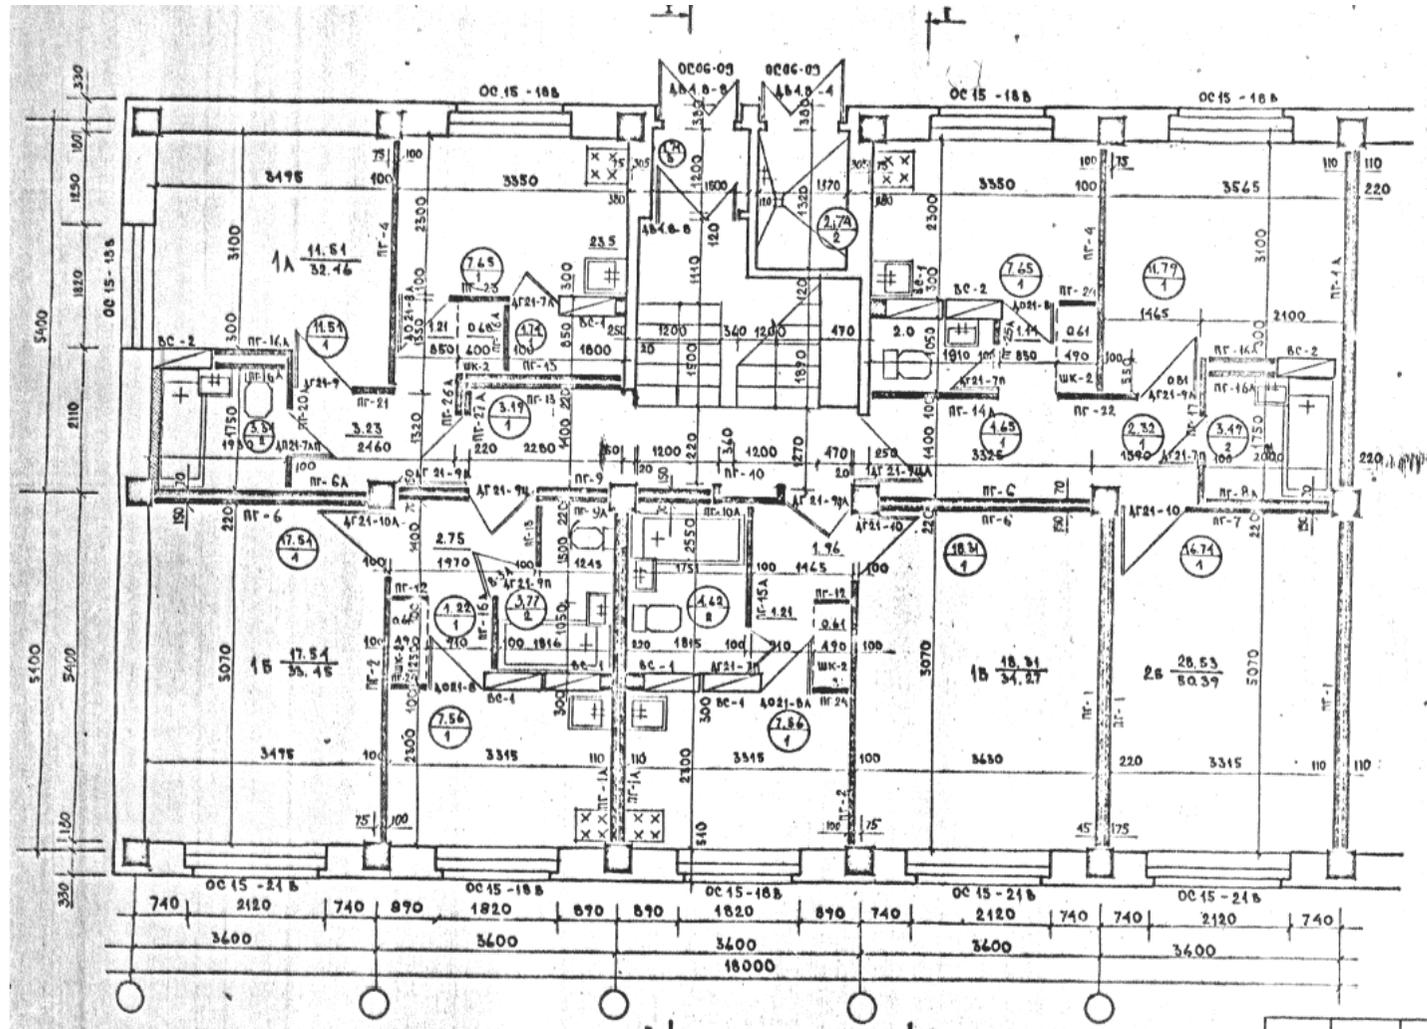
Grundriss Gebäudetyp WP (ohne Maßstab)
